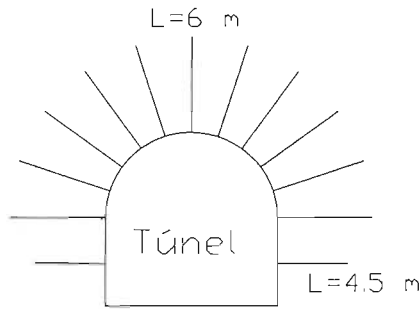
A.- Anclaje de fricción colocado en los túneles de desvío – Sección tipo.
